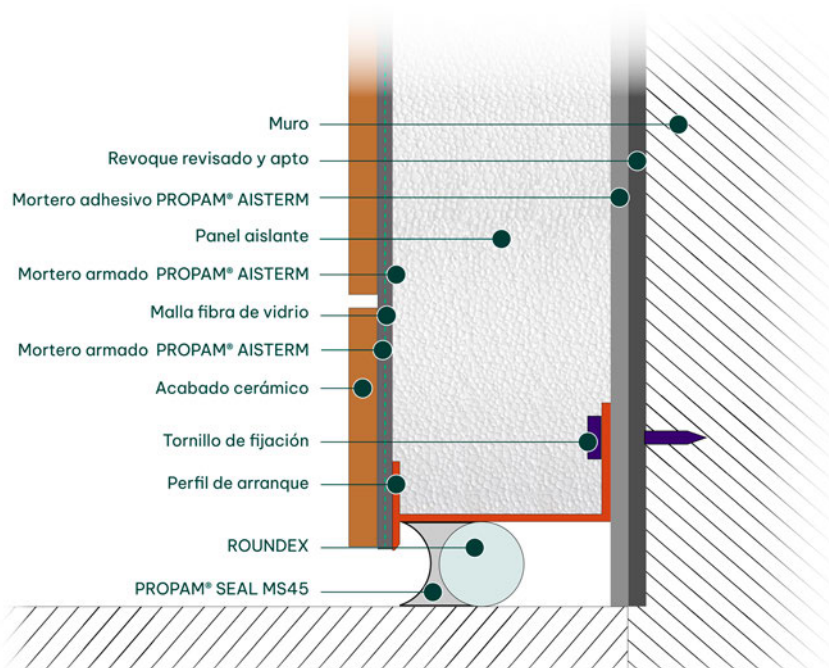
Esquema de un perfil de encuentro fachada con balcón
